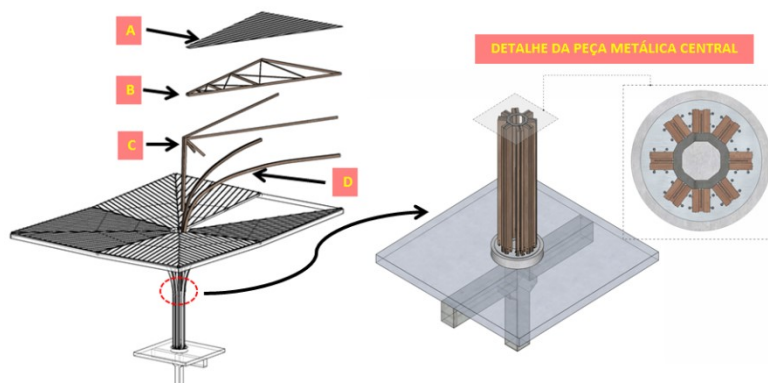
Fixação do Pilaretes em Base de Concreto
